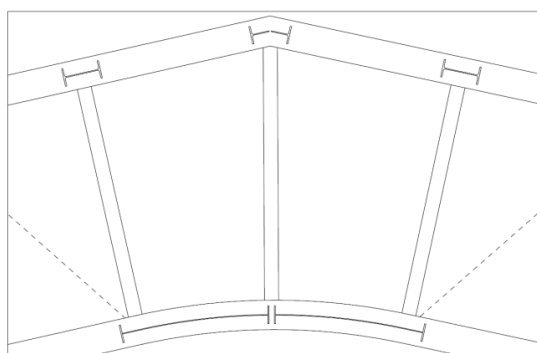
Corte em planta da estrutura metálica na zona junto aos pilares [2]
